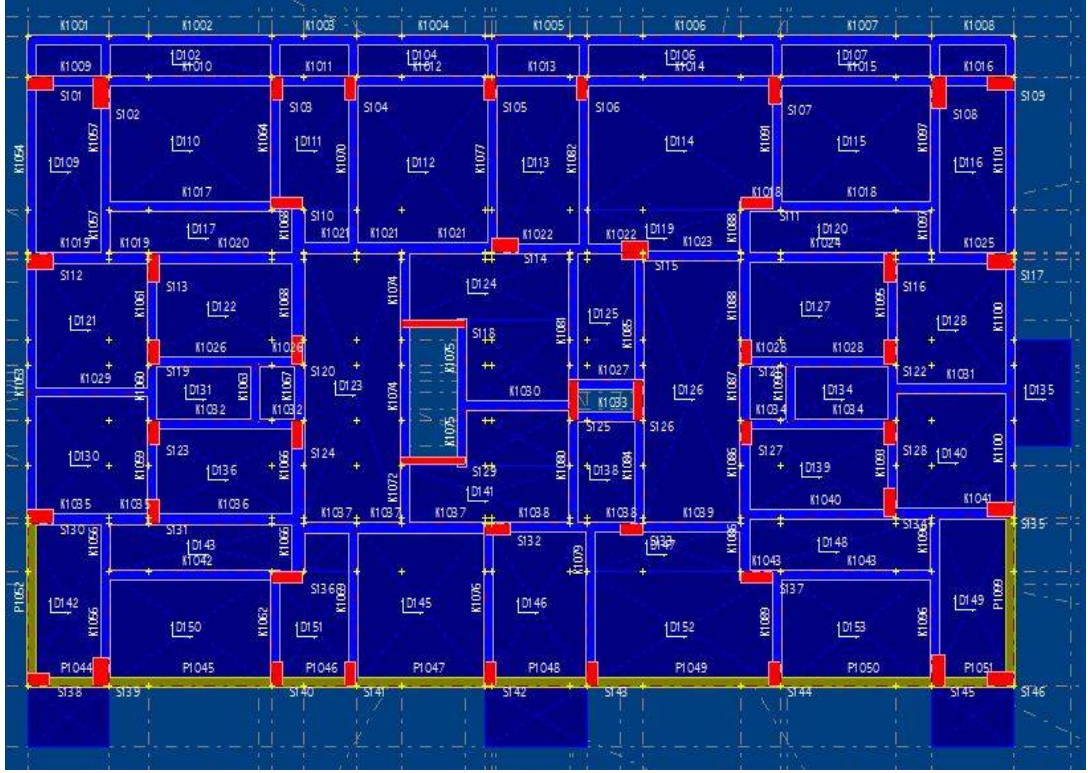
(2) Nolu bina modelleme kat planı
